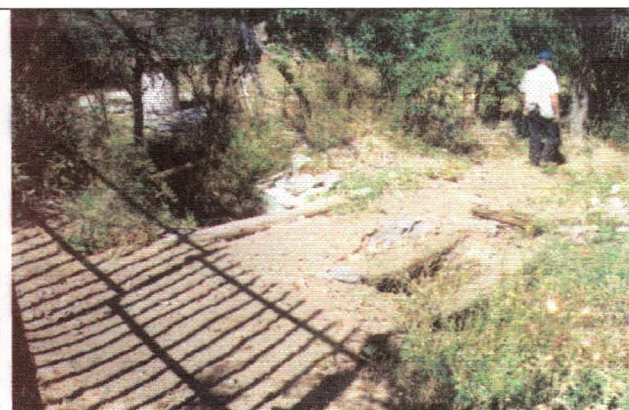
Paso camino. En el sector se observan filtraciones evidenciadas por la vegetación.
